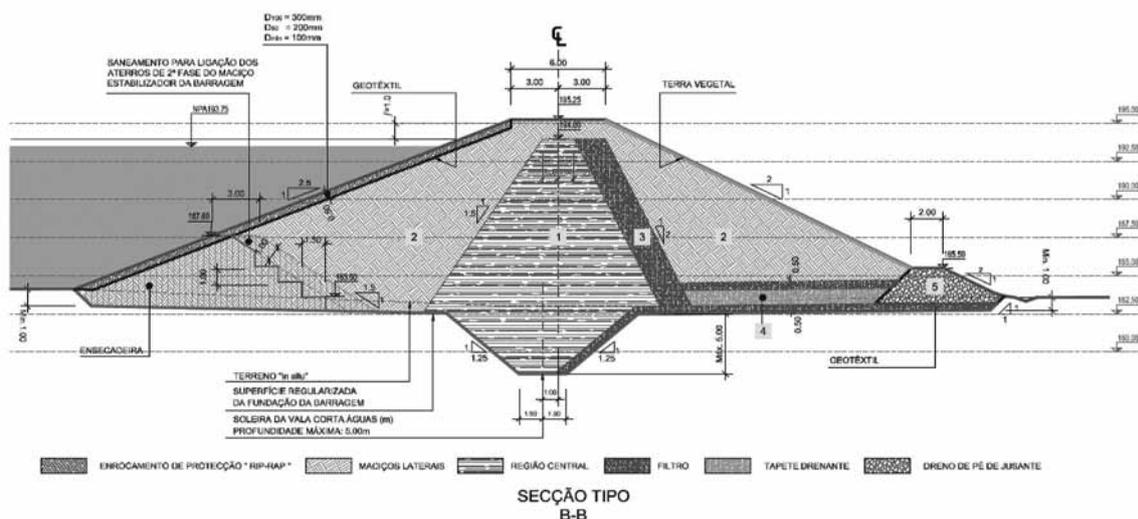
Barragem de Caliços. Perfil Transversal Tipo
